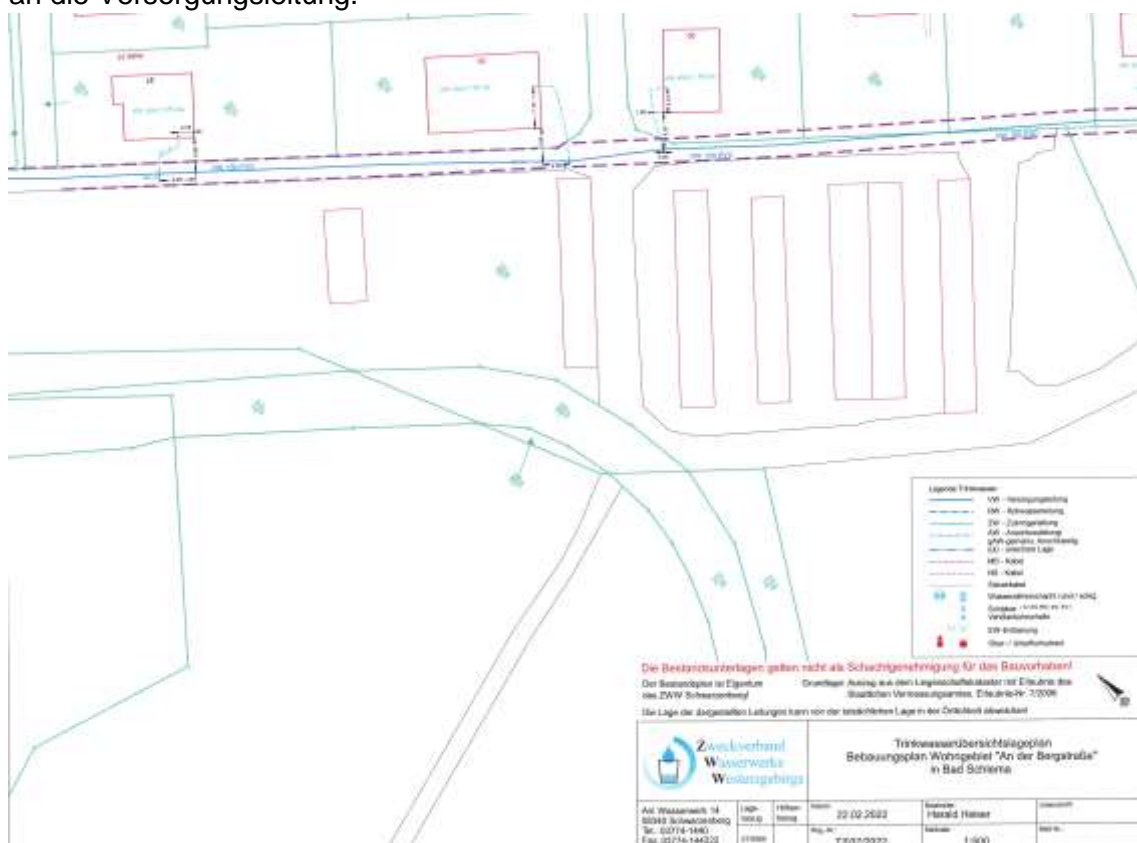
Lageplan Trinkwasser ZWW [4]
